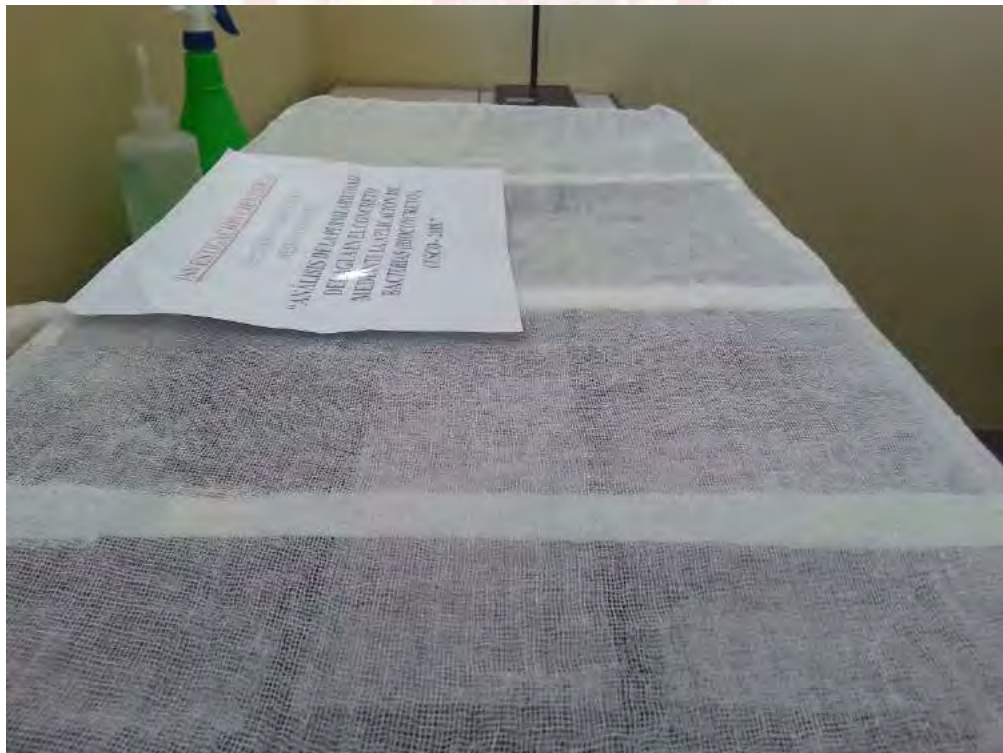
Curación de prismas de concreto fisurado (a base de bacterias).
